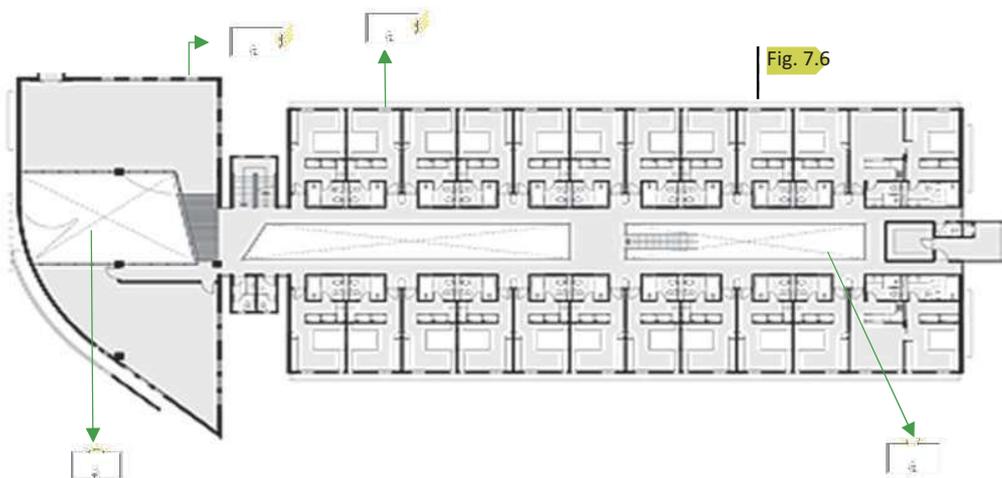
Planta Superior – CPV. Fonte: Arquivos Bloch Arquitetos.
